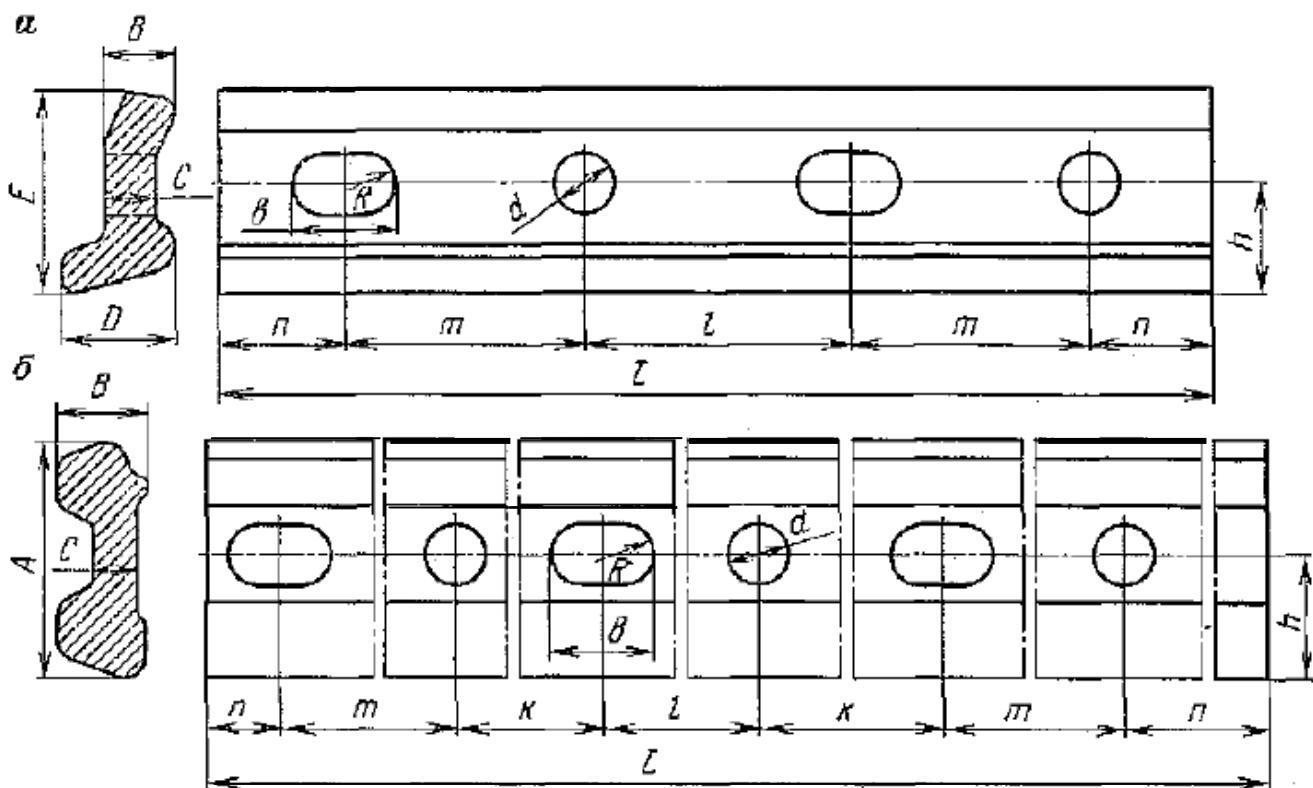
Накладки рельсовые: а – угловые, б – двухголовые
